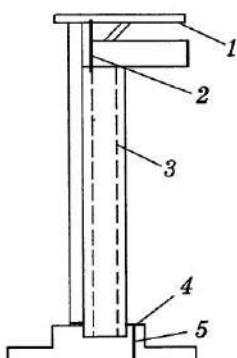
Соединение арматуры железобетонных конструкций:
